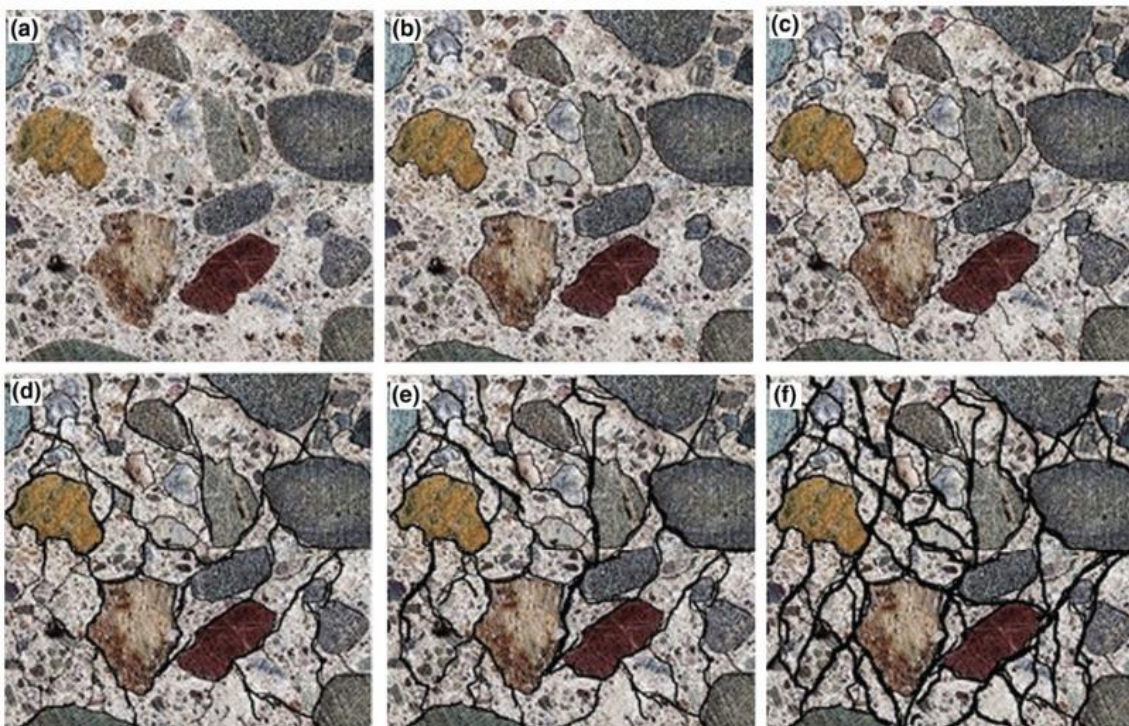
Comportamiento del hormigón bajo tensiones aplicadas. (Singh, 2017)
